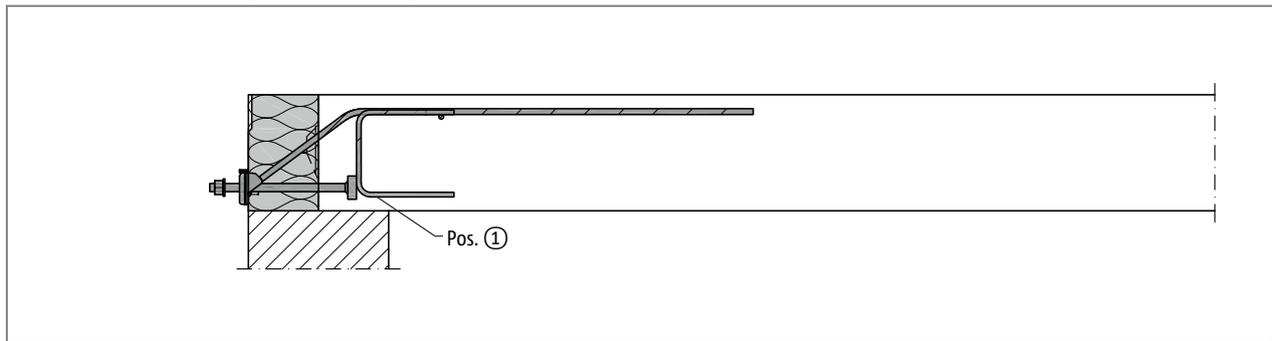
Schöck Isokorb® XT Typ SQ: Bauseitige Bewehrung, Schnitt
